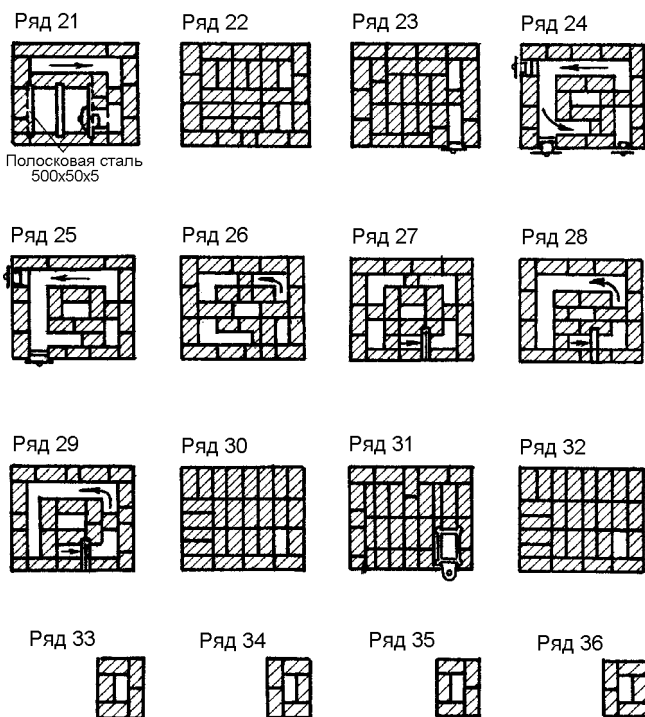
Кладка отопительно-варочной печи И.Ф. Волкова без камеры для выпечки хлеба
